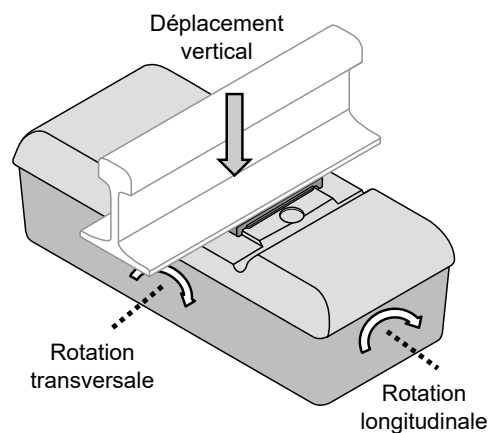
Les mouvements d'un support d'une voie sur dalle
